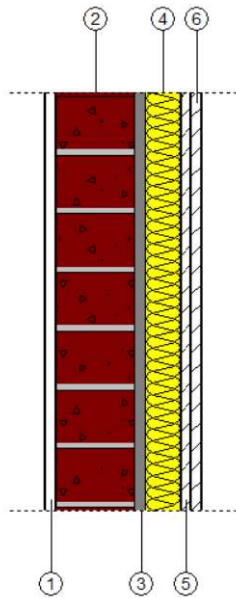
Muros de tabiquería interior entre oficinas y nave itv.
